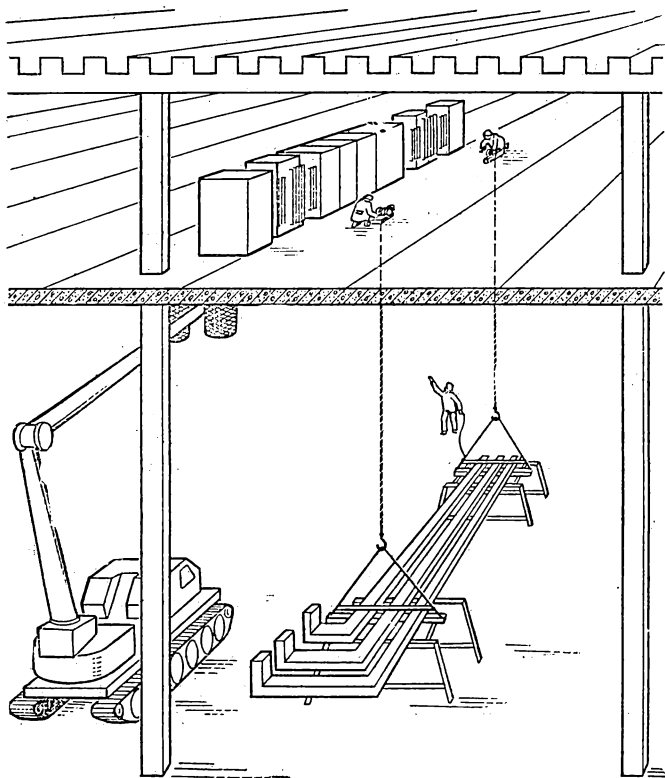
Монтаж открытого шинопровода на подвесных конструкциях под перекрытием подстанции.
